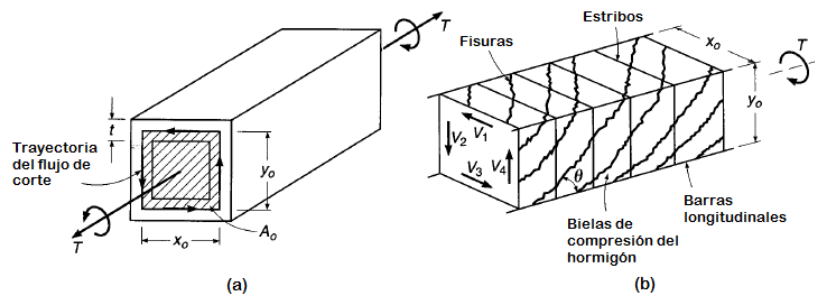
a) Idealización como tubo de pared delgada en sección no fisurada.
